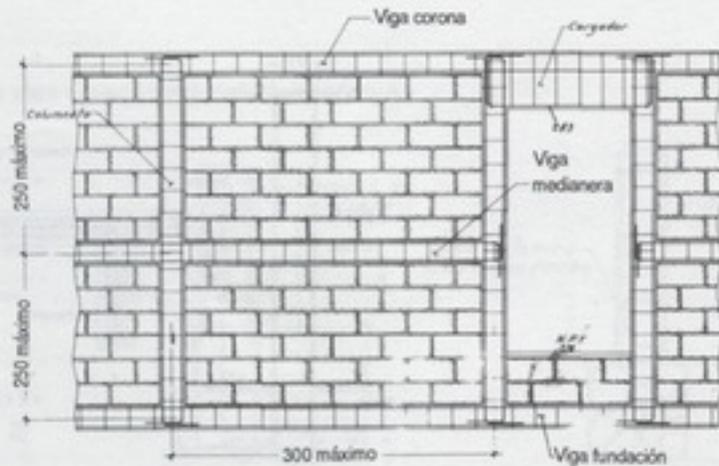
Elevación típica de pared mampostería confinada.
